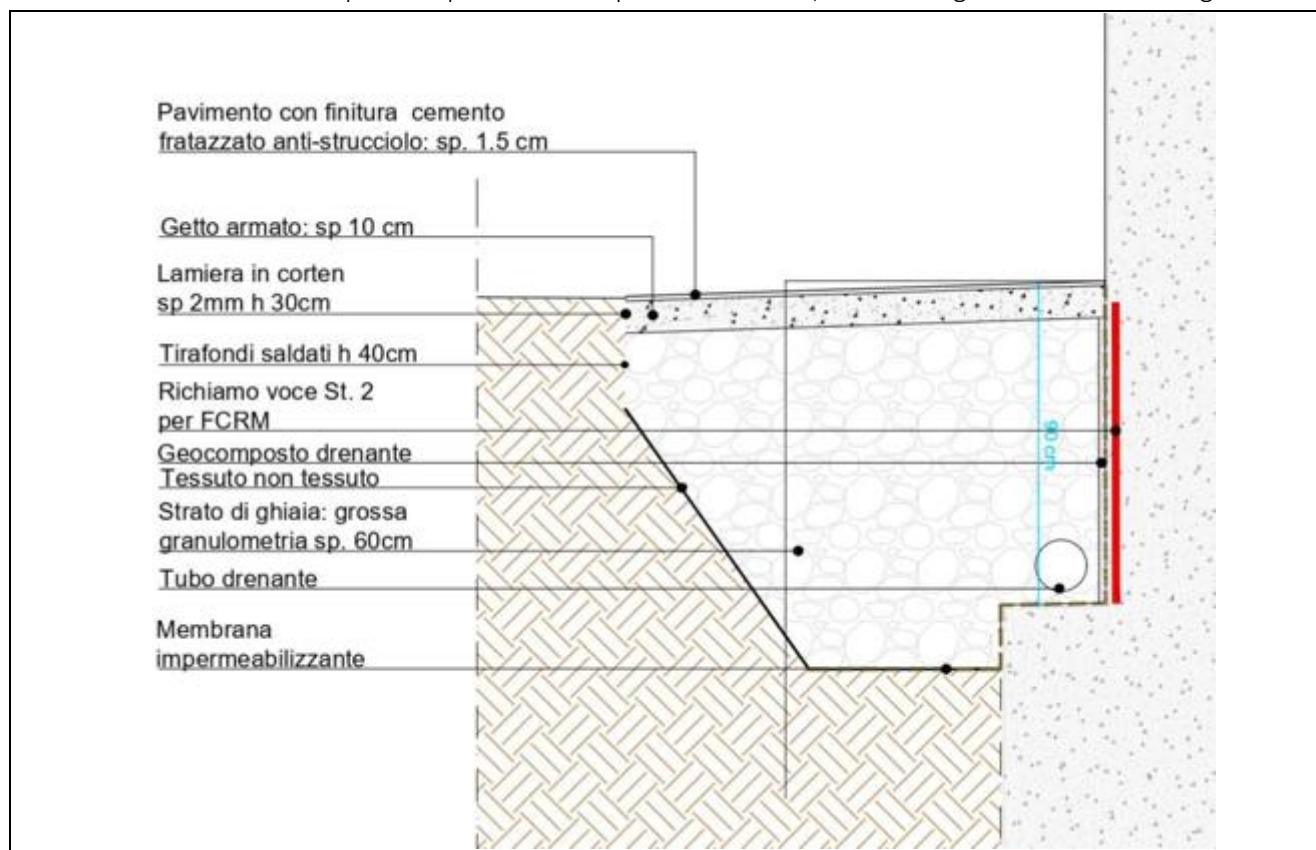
sezione di riempimento degli scavi perimetrali per il consolidamento fondazioni.
